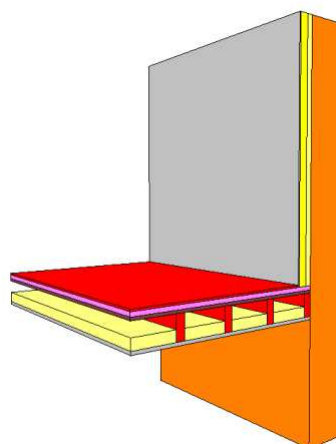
Trisco : vue 3D du nœud constructif formé par l'intersection du mur isolé par l'intérieur et du plancher du R+1
